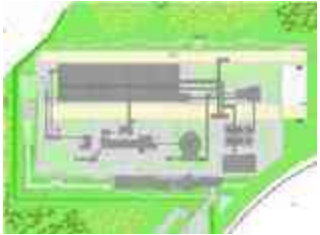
Plano de conjunto, Cervecería Bavaria. 2012 (Fuente: Plataforma de arquitectura).
